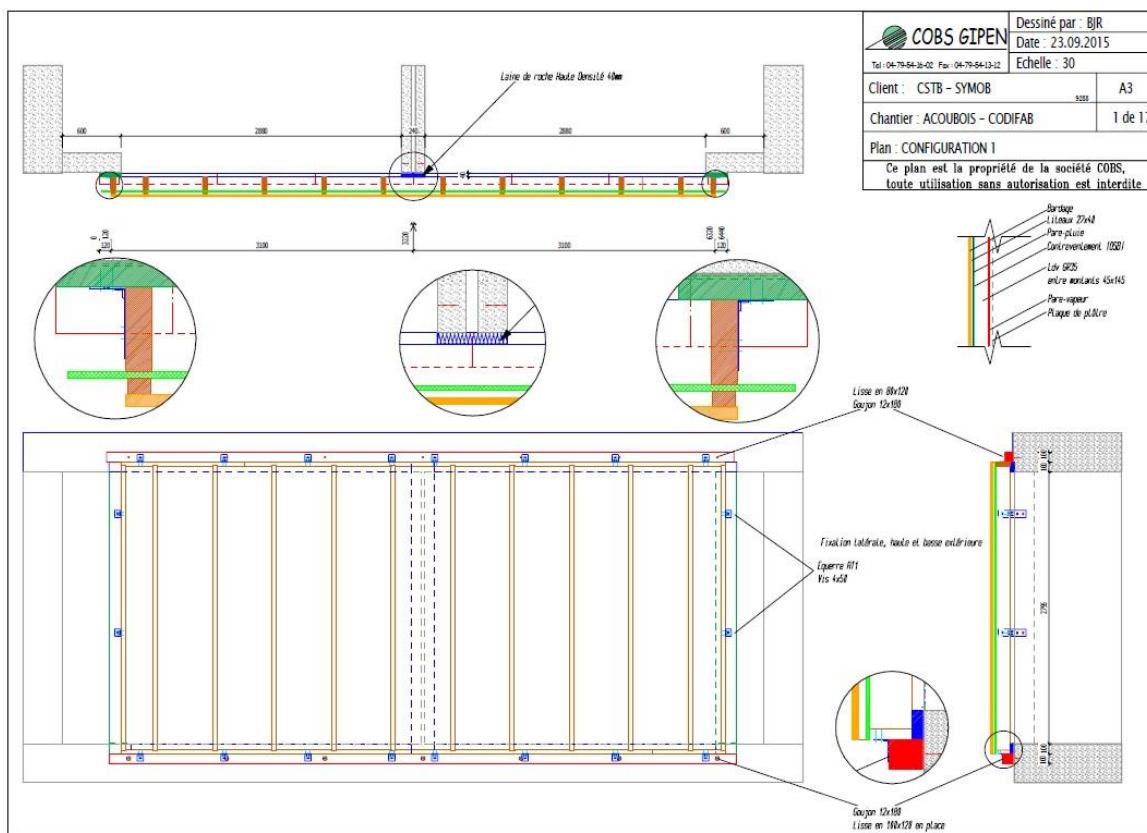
Façade d'un seul tenant avec contreventement extérieur.
